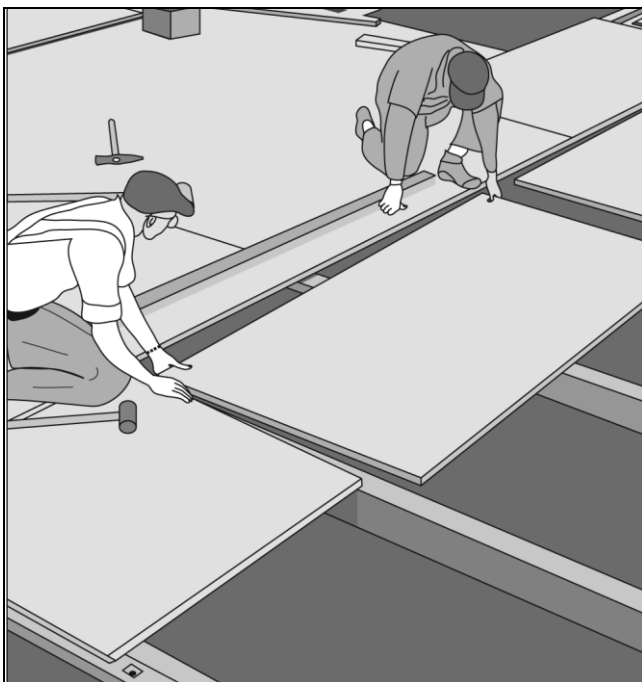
Шпунтовое крепление пола (American Plywood Association)
